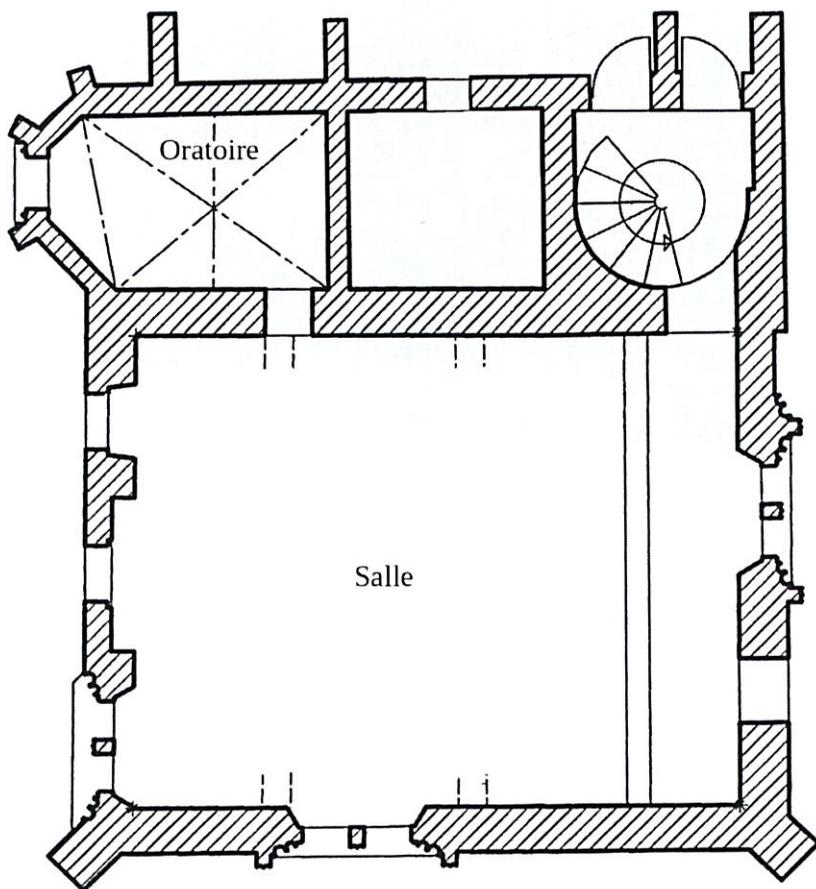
Plan du premier étage. Xavier d'Alençon.
